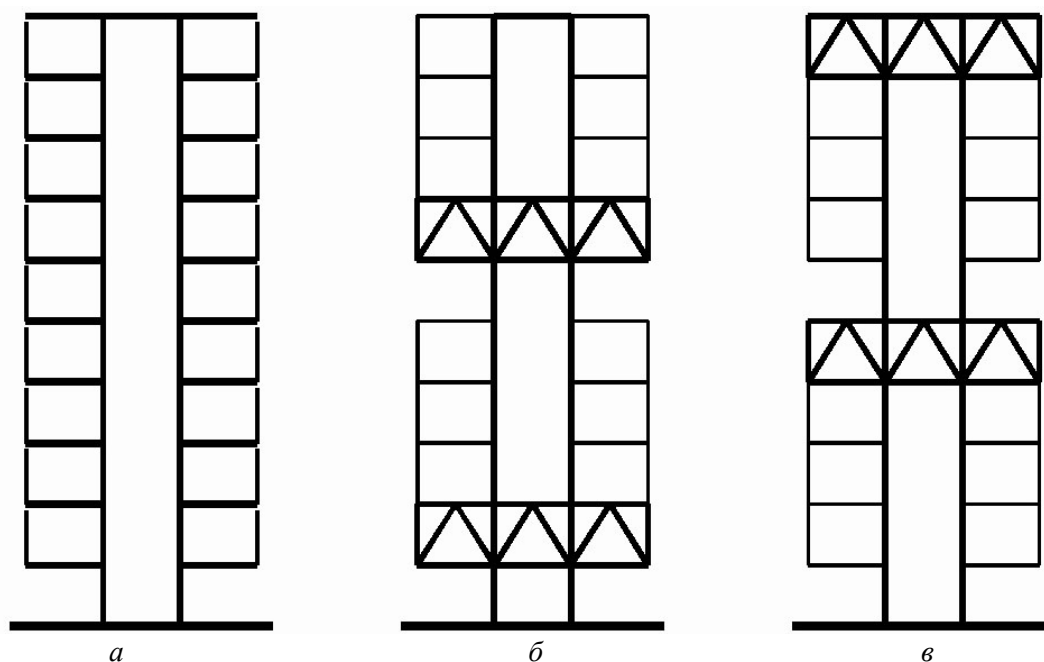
Ствольные каркасы с этажами на консольных балках (а), с этажами на консольных фермах (б), с подвешенными перекрытиями (в)
